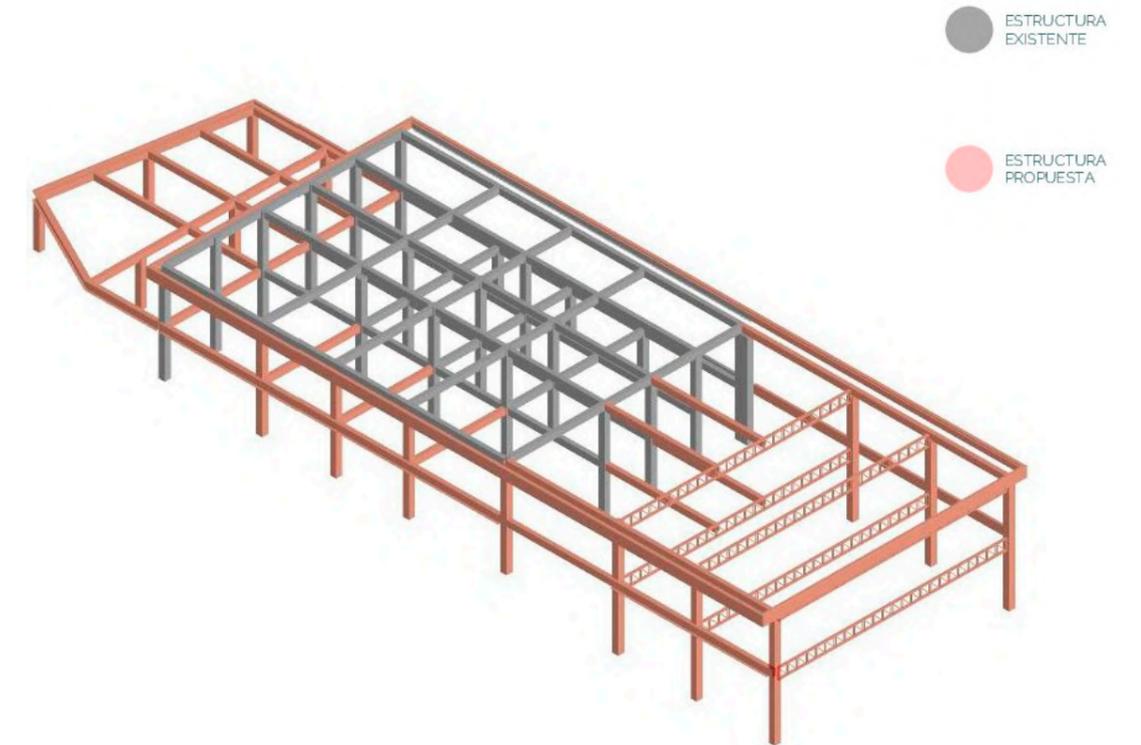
| Reciclaje de estructuras | Fuente: Elaboración propia
